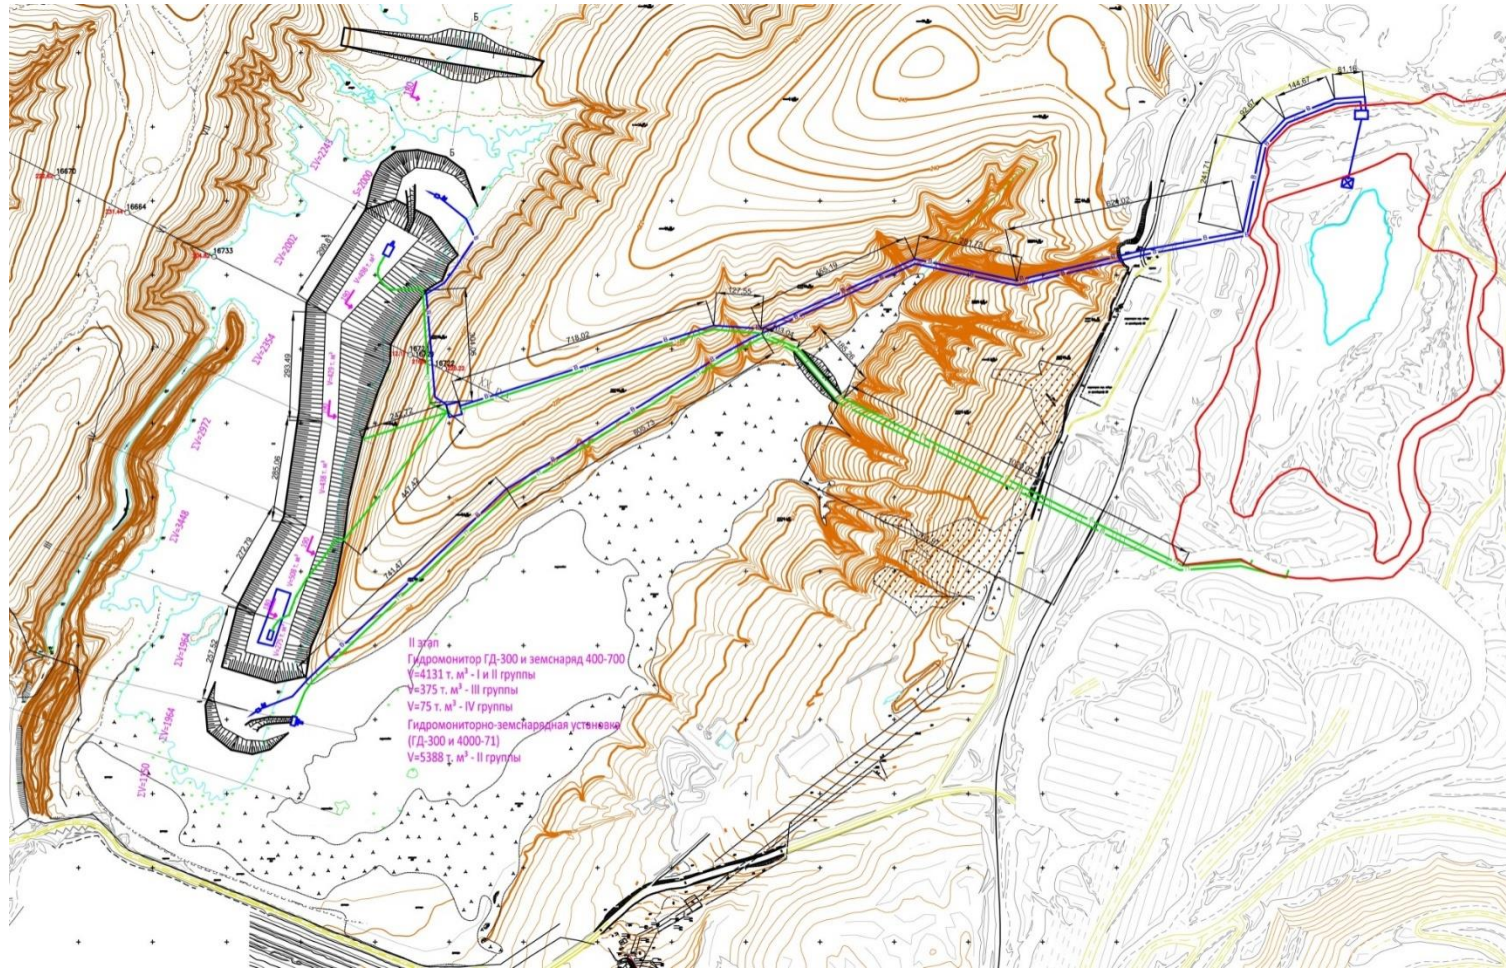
План горных работ на период ввода в эксплуатацию гидромониторно-земснарядного и гидромониторно-землесосного комплексов для разработки пород, намывных ранее в гидроотвал №2 разреза «Черниговец», и перемещения их на новое место укладки
